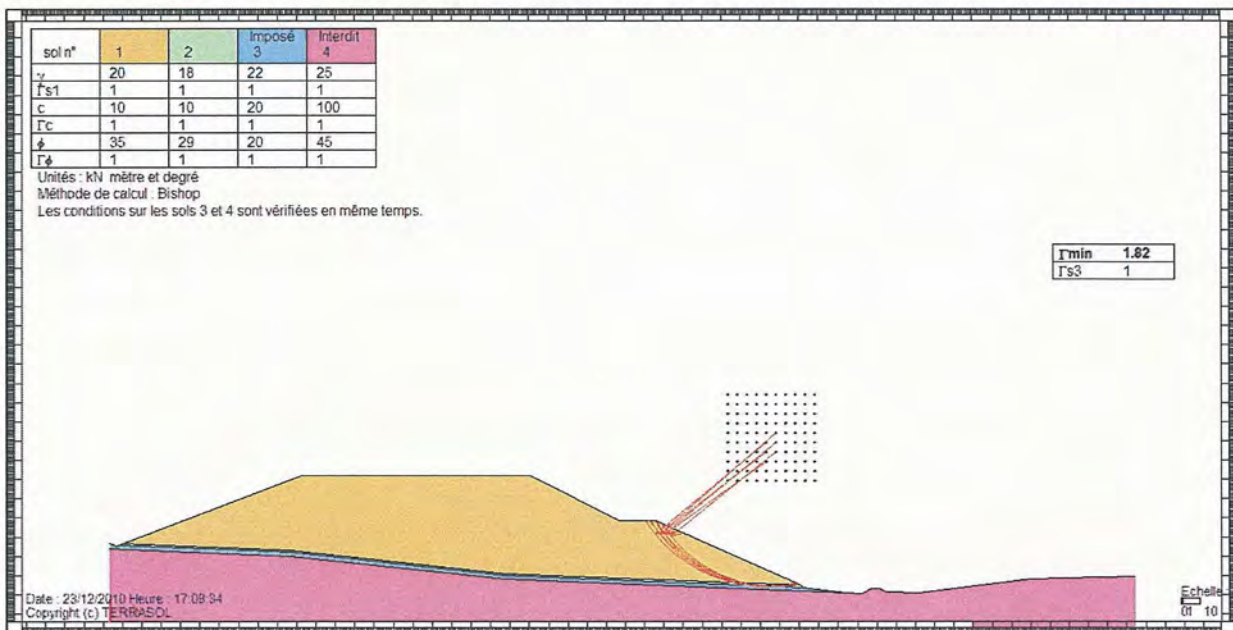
Coupe 3 : Stabilité vis-à-vis d'un glissement profond
